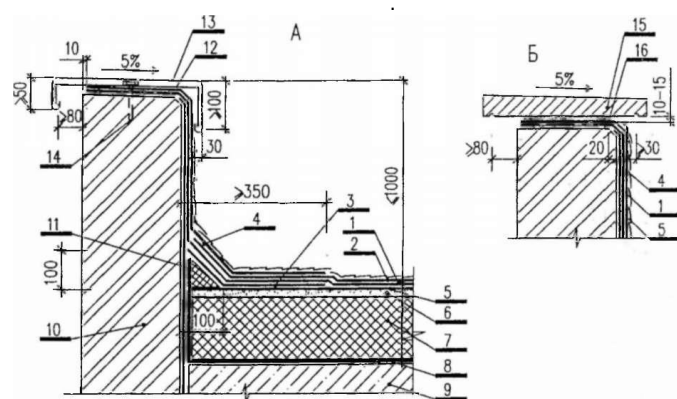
Примыкание двухслойной кровли с выводом на парапет:
